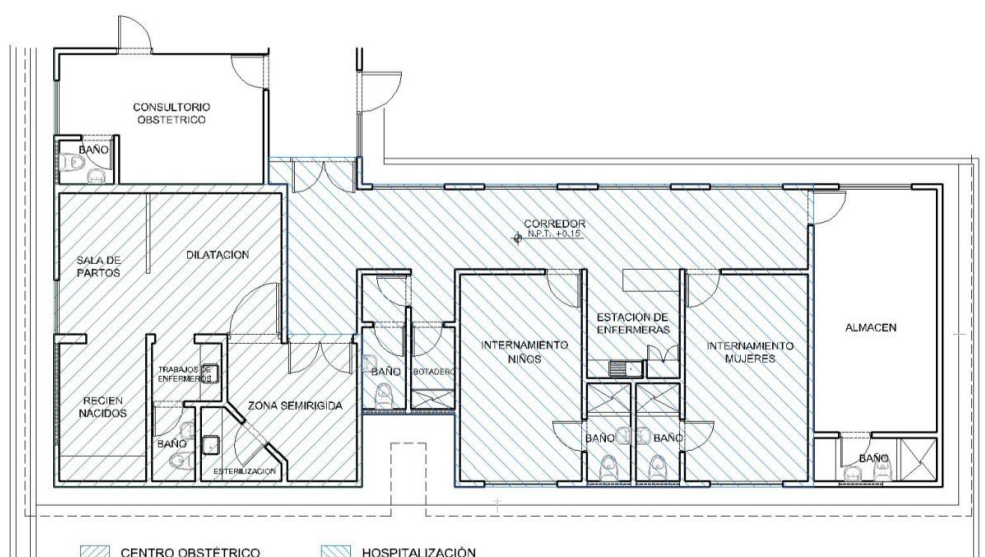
PLANO DE PLANTA BLOQUE 3 – PAIMAS I-4
